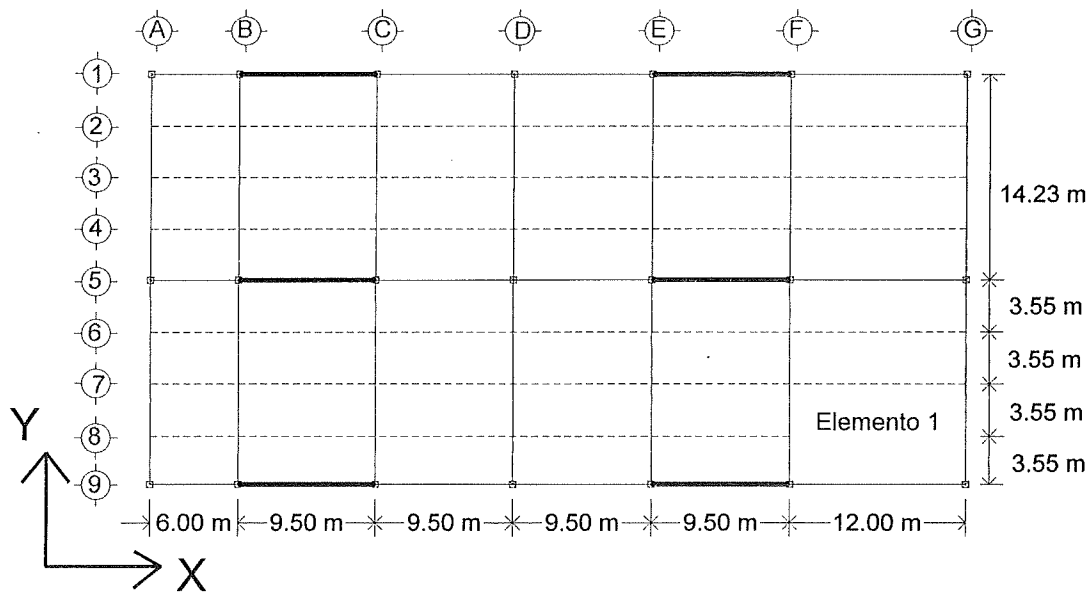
Vista en planta del elemento que se prediseñará, (elemento 1).
